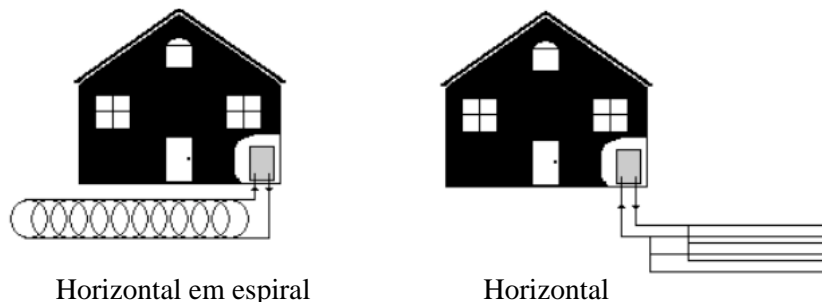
Configurações de circuito fechado horizontais (adaptado de Swenka, 2008)
